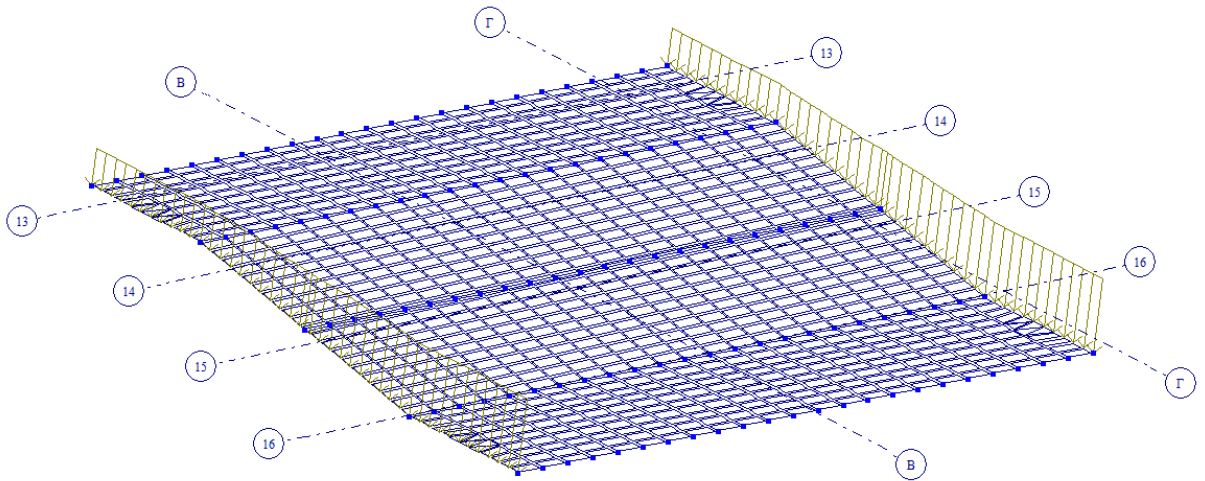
Нагрузка на днище от веса продольных стенок
